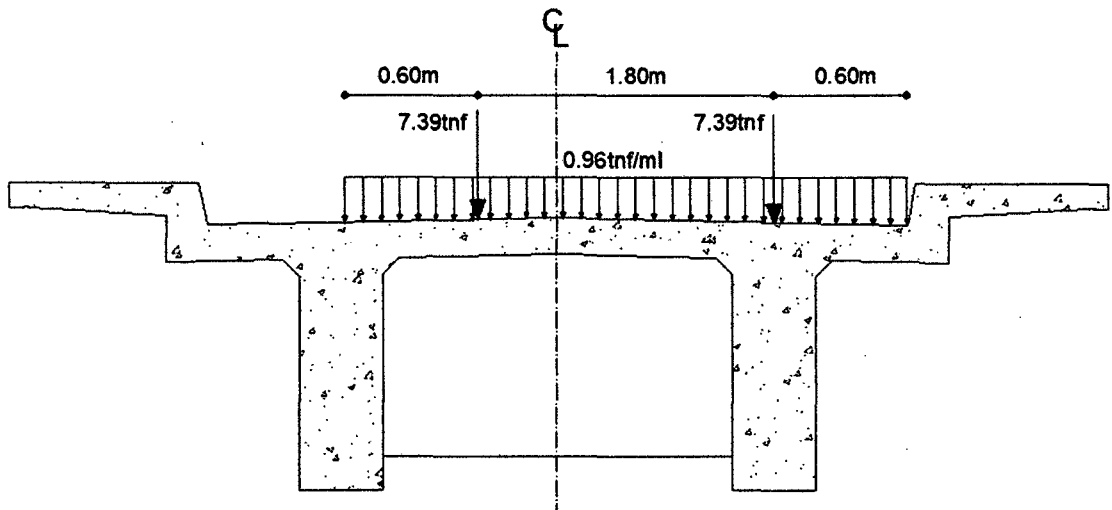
Ubicación de la carga móvil excéntrica sobre la viga diafragma - Para el Primer y Tercer Tramo.
